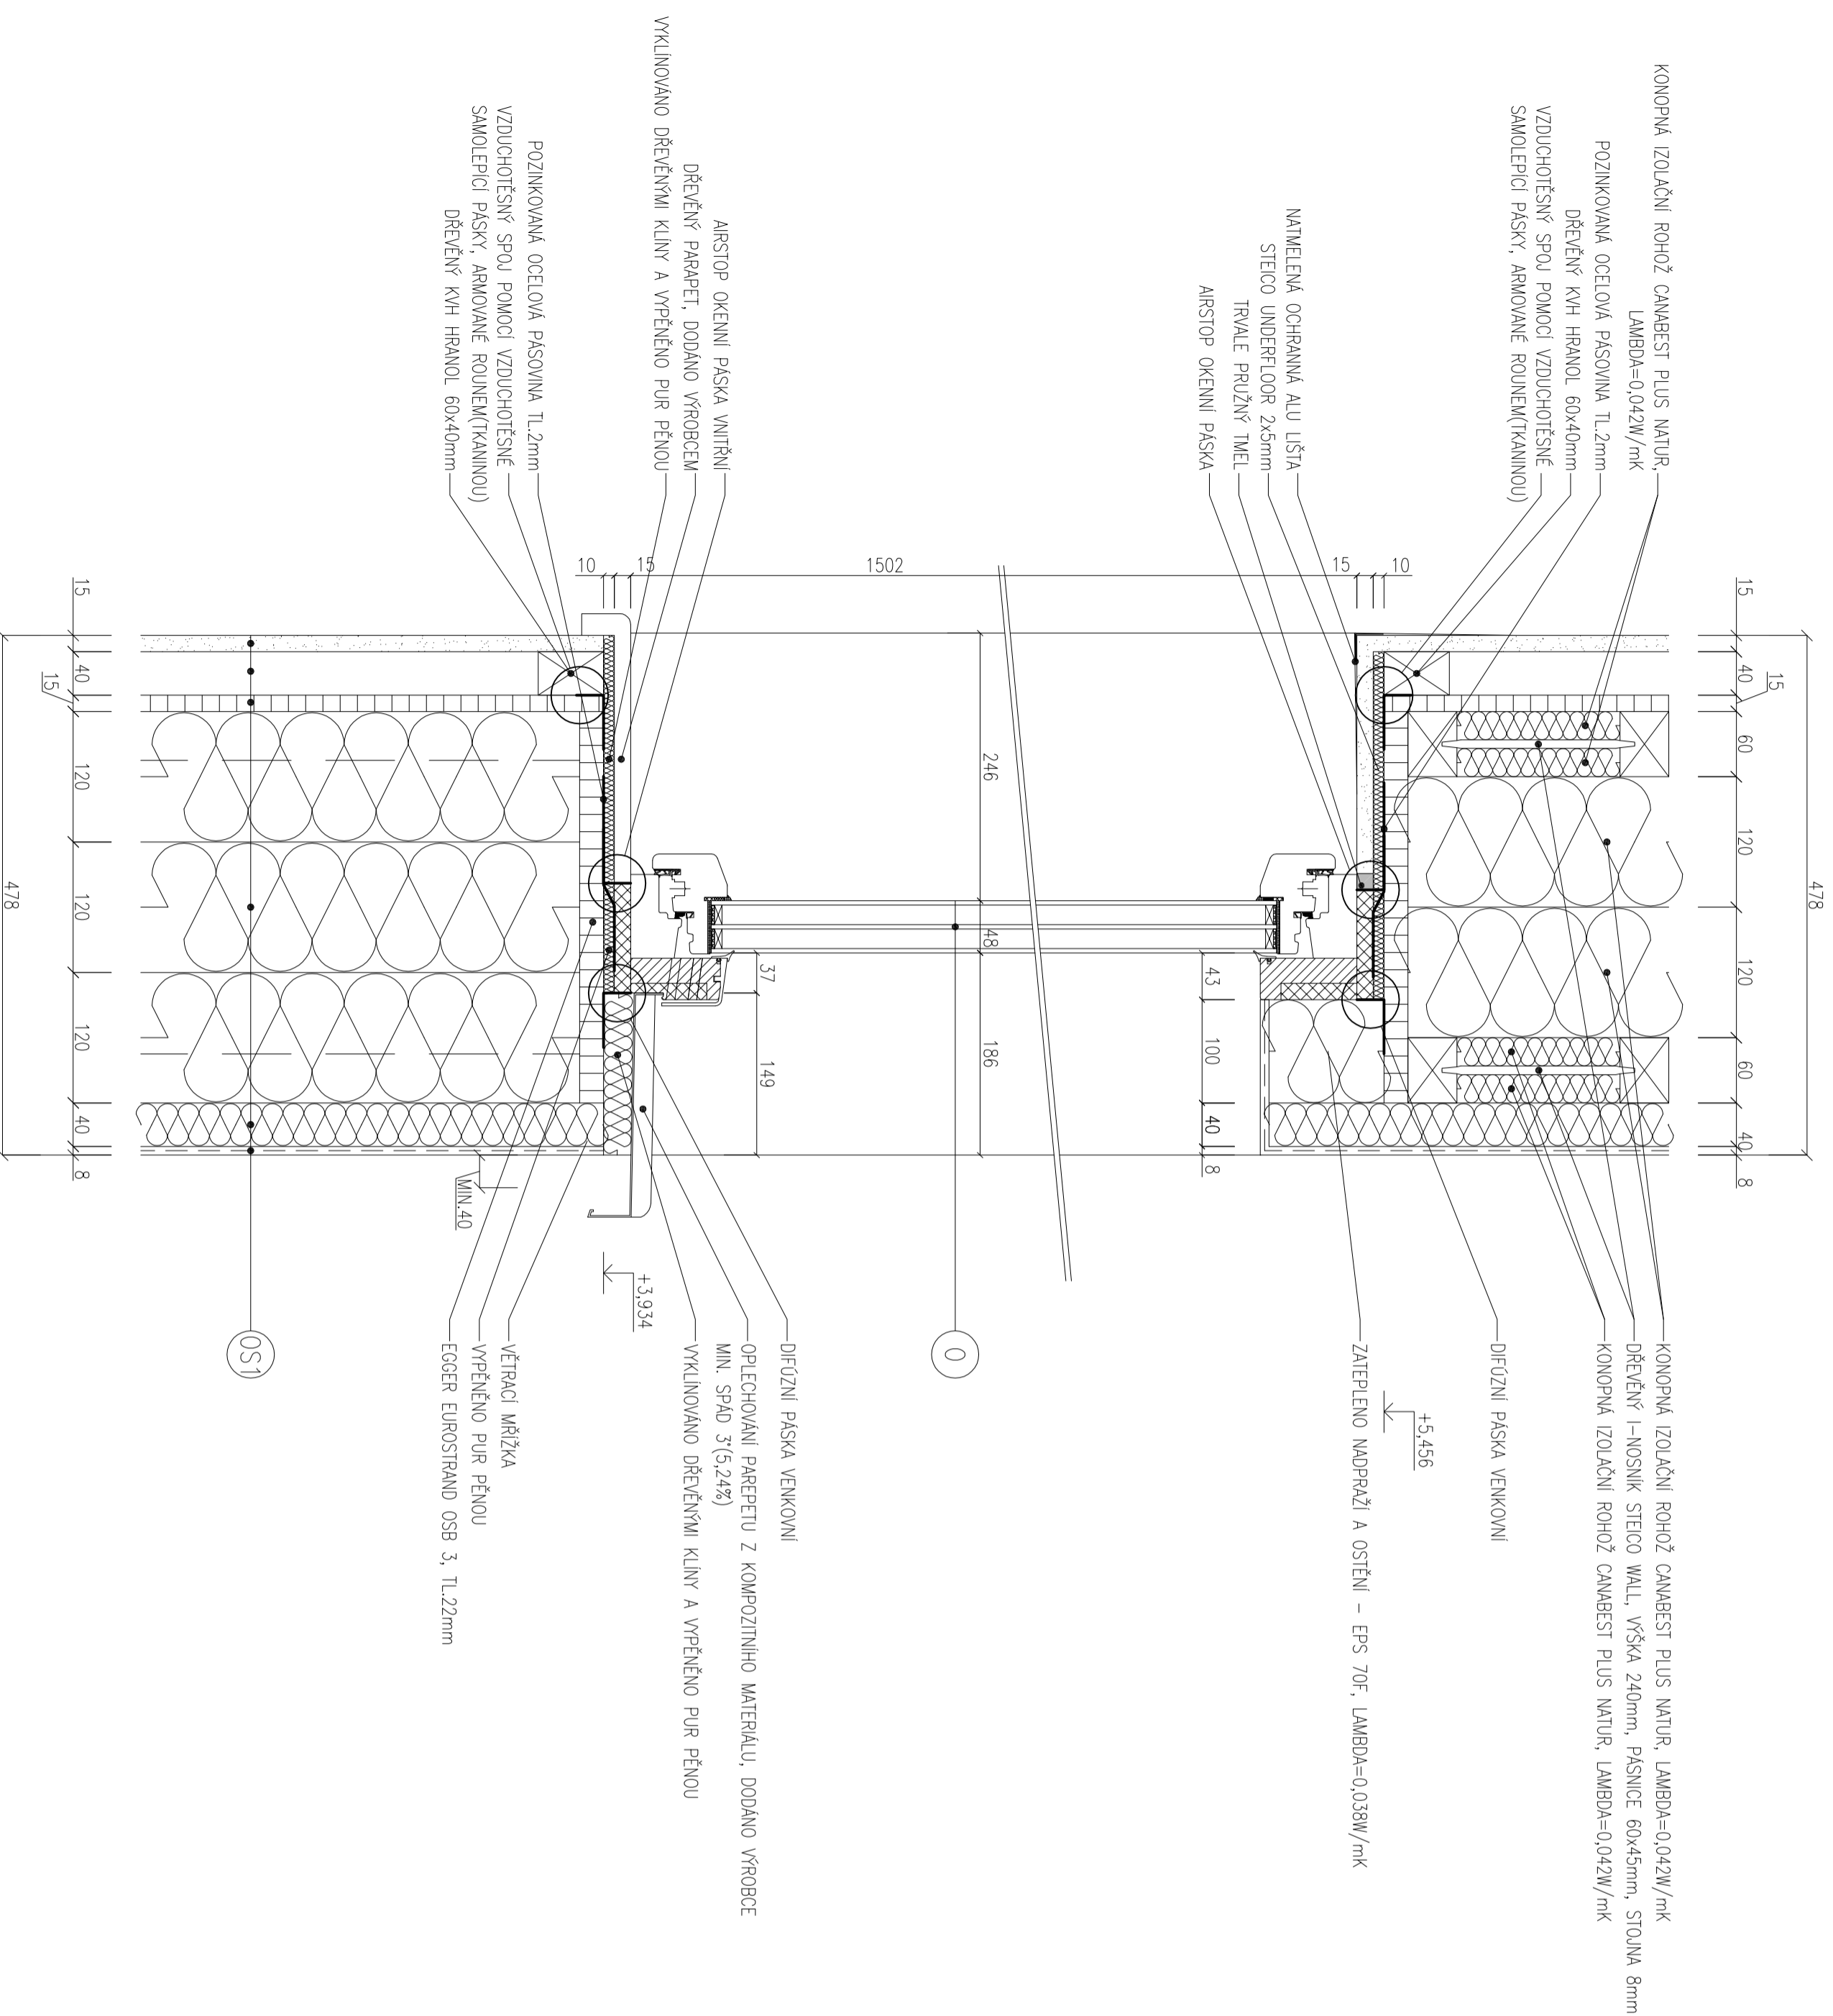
DETAIL PARAPETU A NADPRAŽÍ OKNA 203
